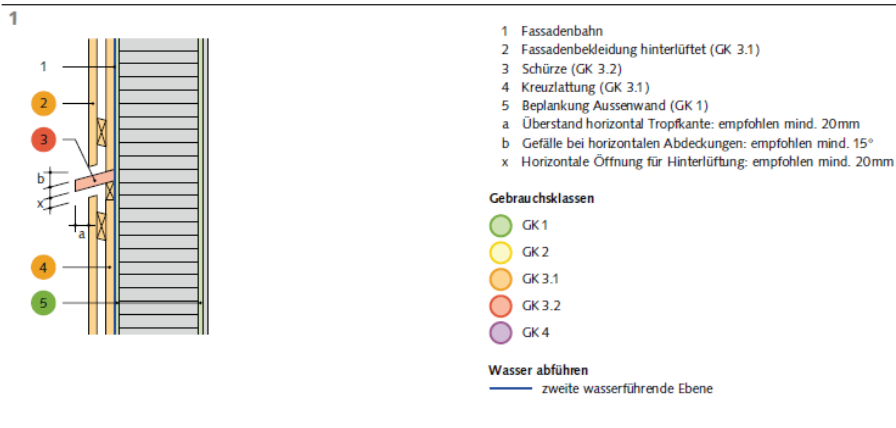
Detail Fassade (horizontale Unterteilung als konstruktive Schutzmassnahme und Brandschutzmassnahme pro Geschoss [2])
